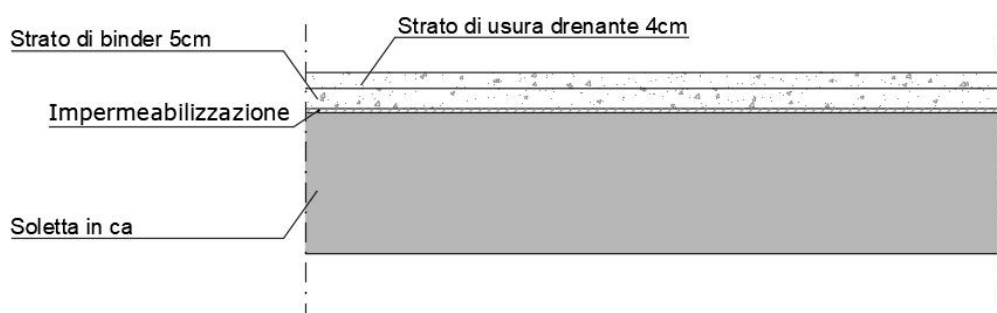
Composizione sovrastruttura autostrada su impalcato– TIPO P1C
